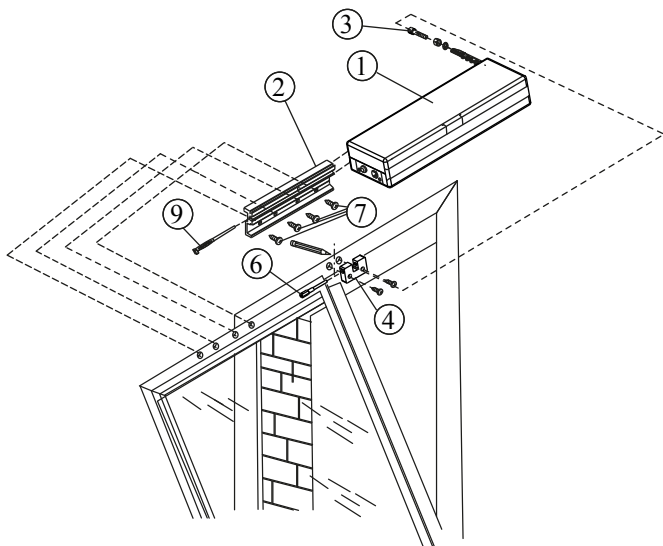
Схема монтажа открывание внутрь, крепление привода на створку
